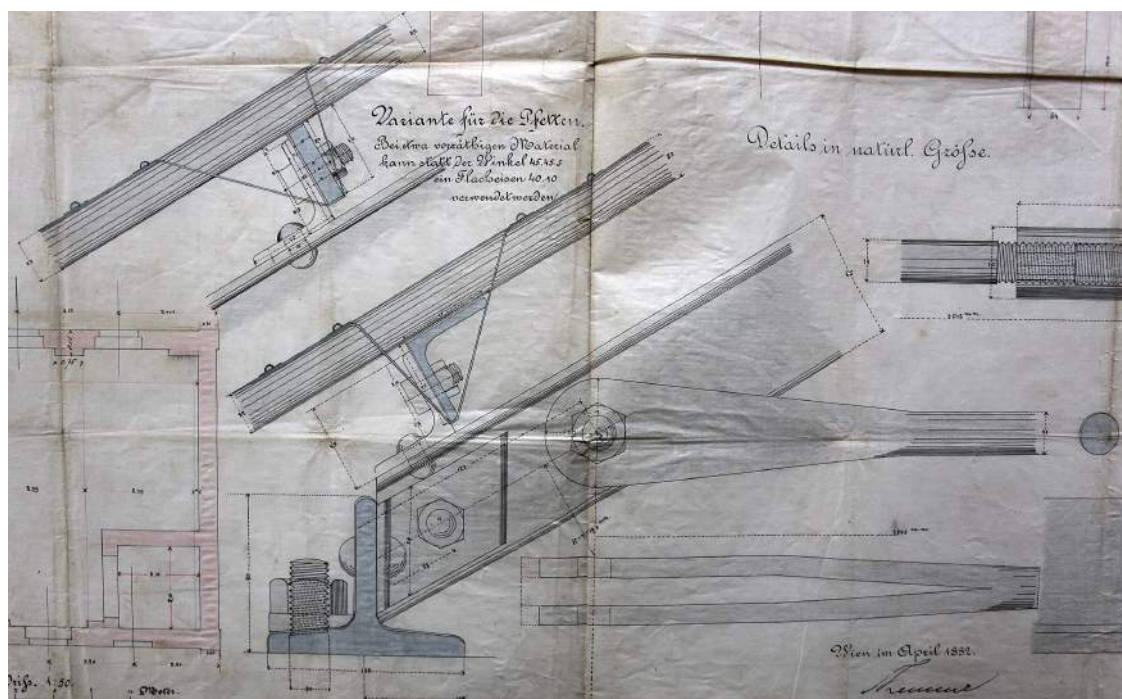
Konstruktionsdetails des Tonnendaches der Gießerei
